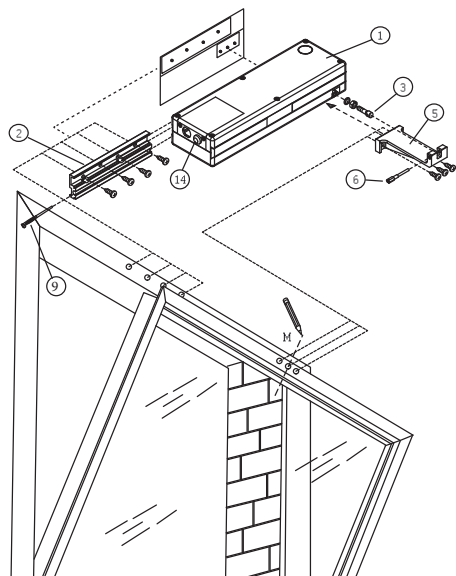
Схема монтажа "открытие внутрь", крепление привода на раму
